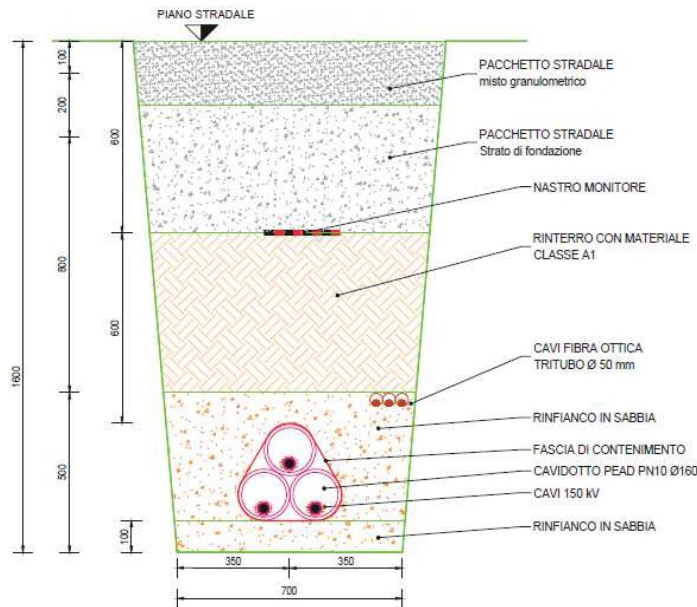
Sezione tipo cavidotto AT su strada asfaltata
